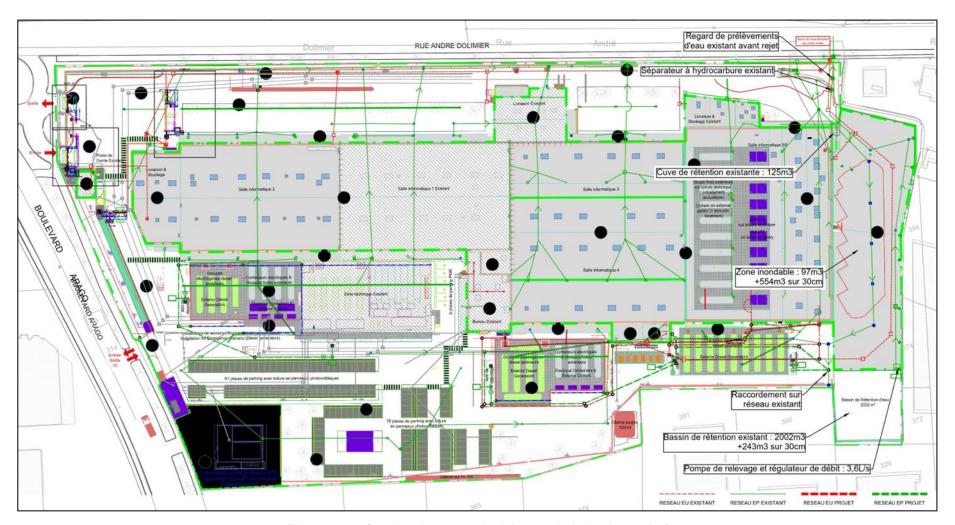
Gestion des eaux pluviales au droit du site projeté
